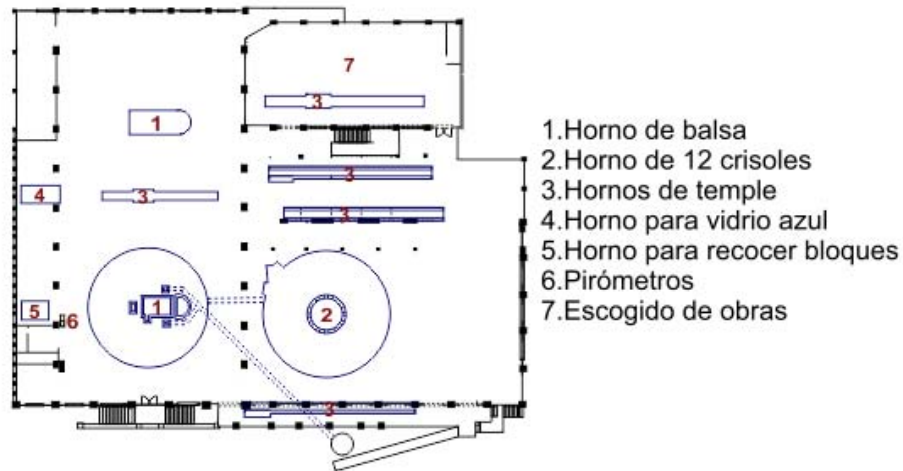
Distribución en planta Primera planta 1956 (alternativa 2)
